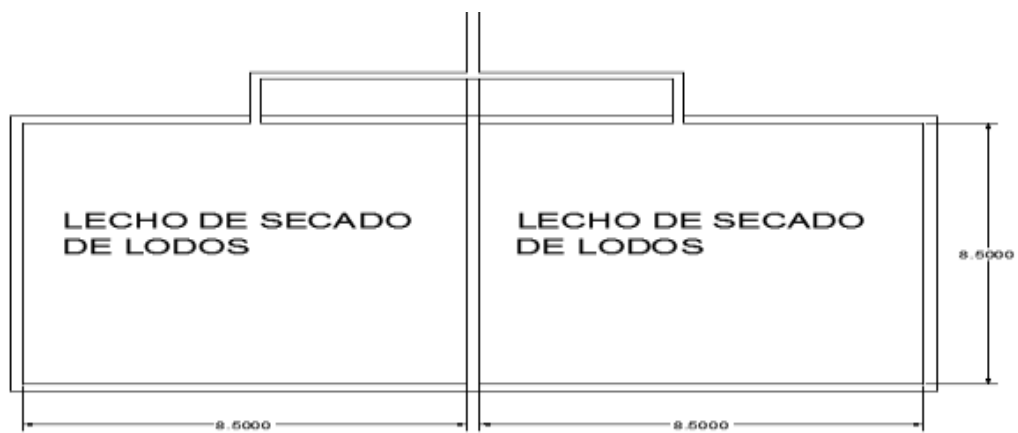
Vista en planta de lecho de secado de lodos.
